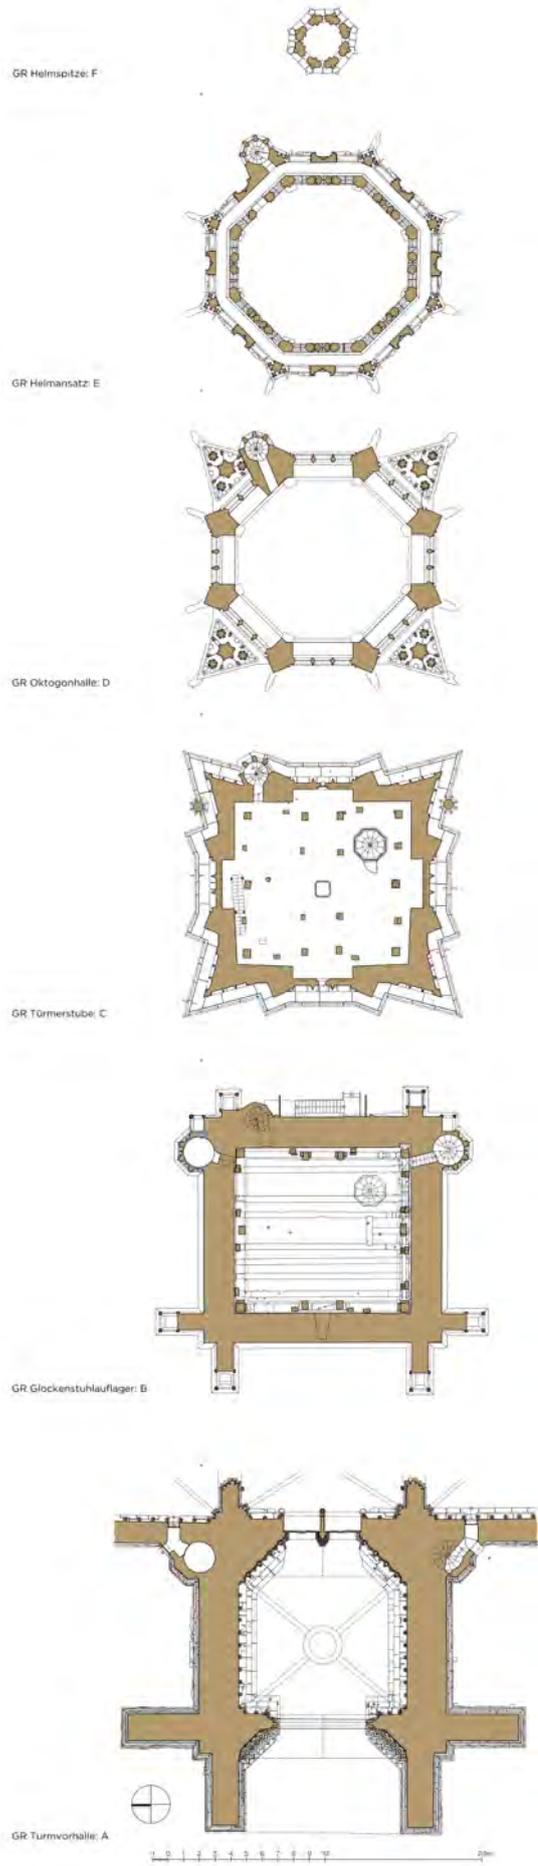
Grundrisse verschiedener Turmebenen, Bauaufnahme
